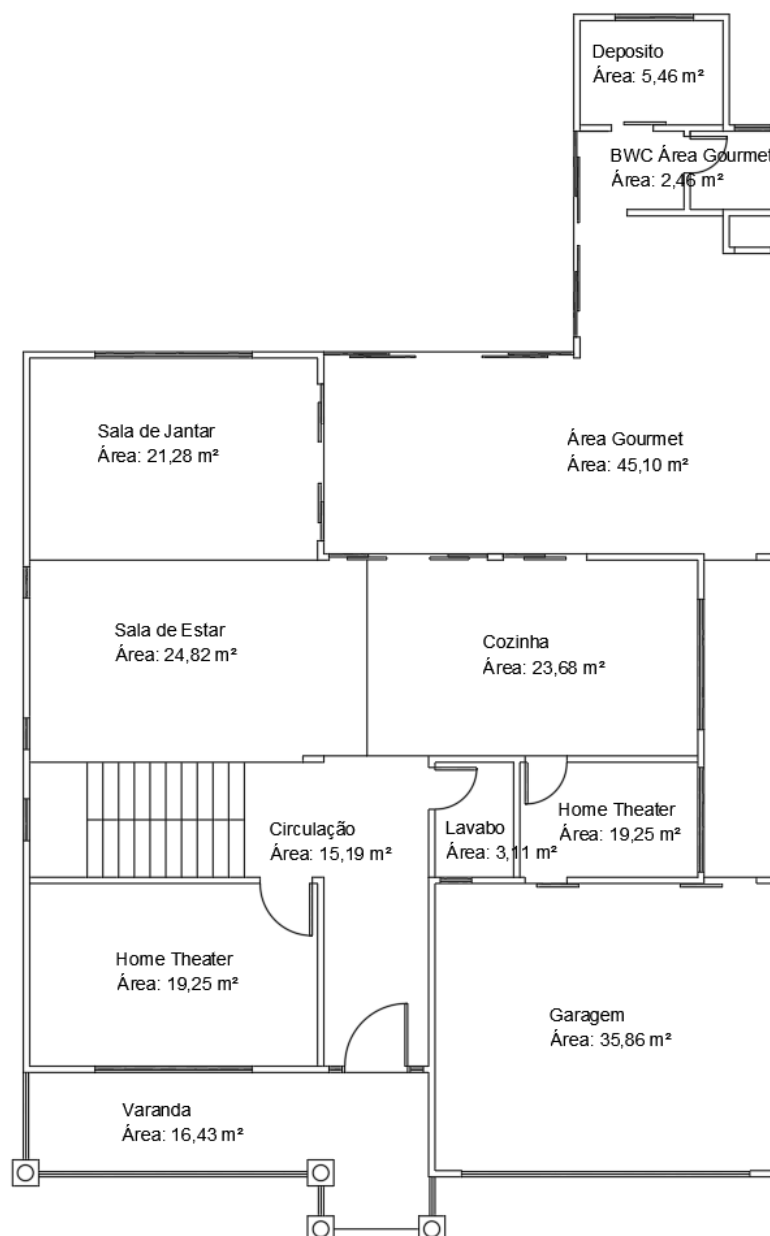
Planta baixa do primeiro pavimento da residência grande.
